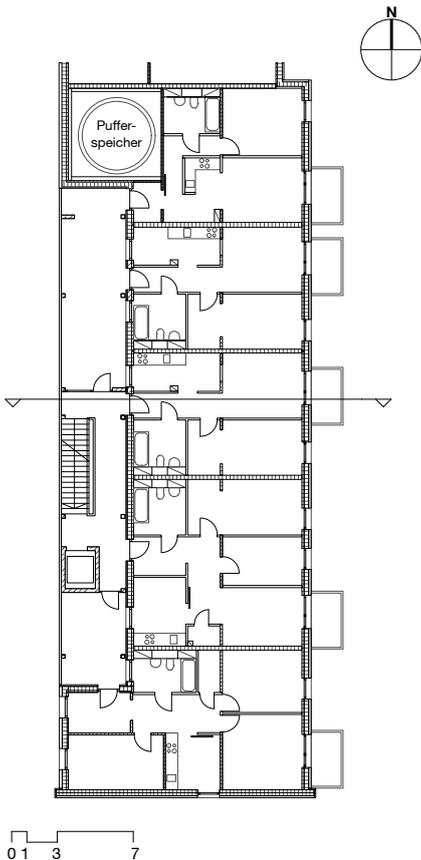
Teilausschnitt Grundriss Regelgeschoss
